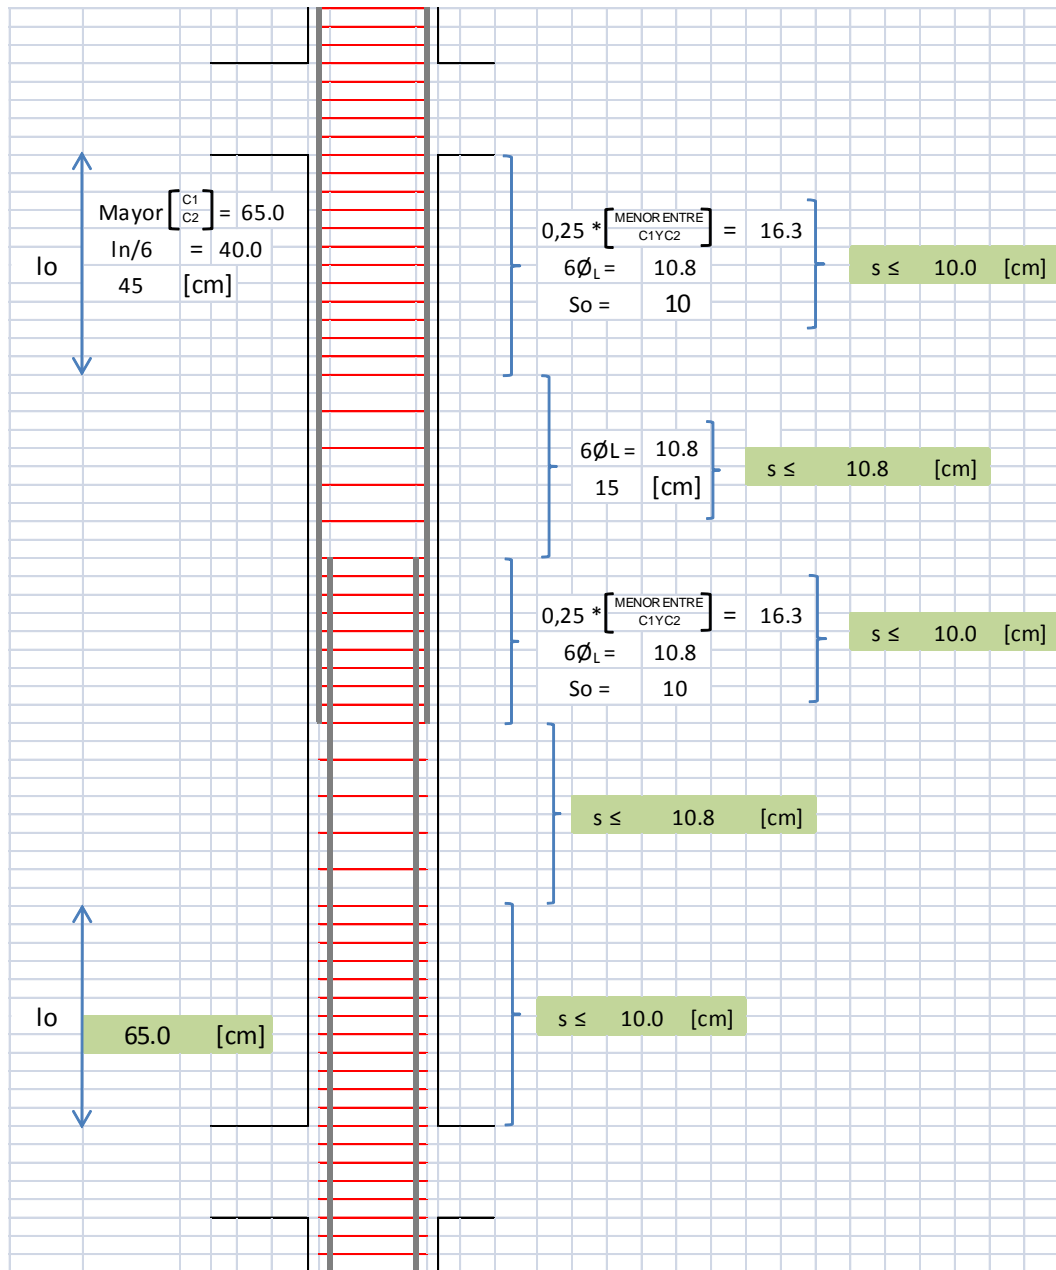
Detalle de la armadura de refuerzo transversal para la columna de 65x65 cm.
